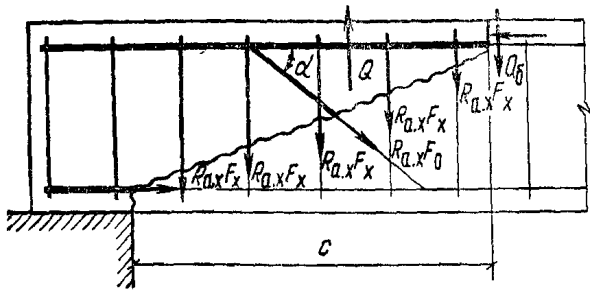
Схема усилий в сечении, наклонном к продольной оси железобетонного элемента, при расчете его по прочности на действие поперечной силы
